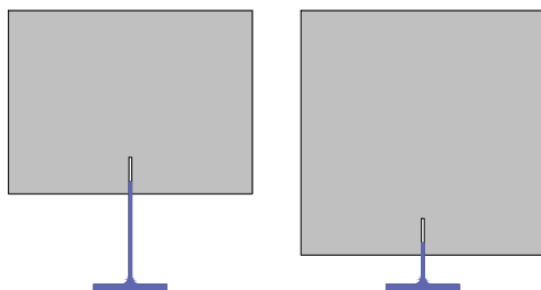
Przekrój hybrydowy zbliżony do przekroju żelbetowego
